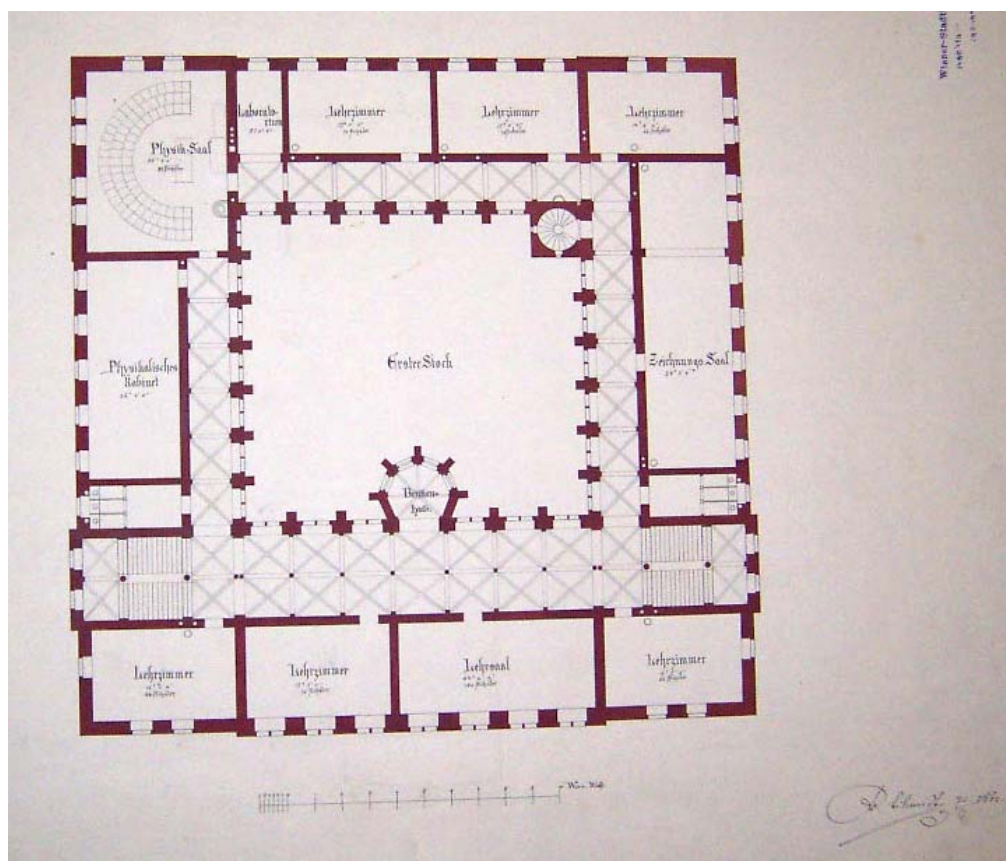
Grundrissplan, Erster Stock, 1862
